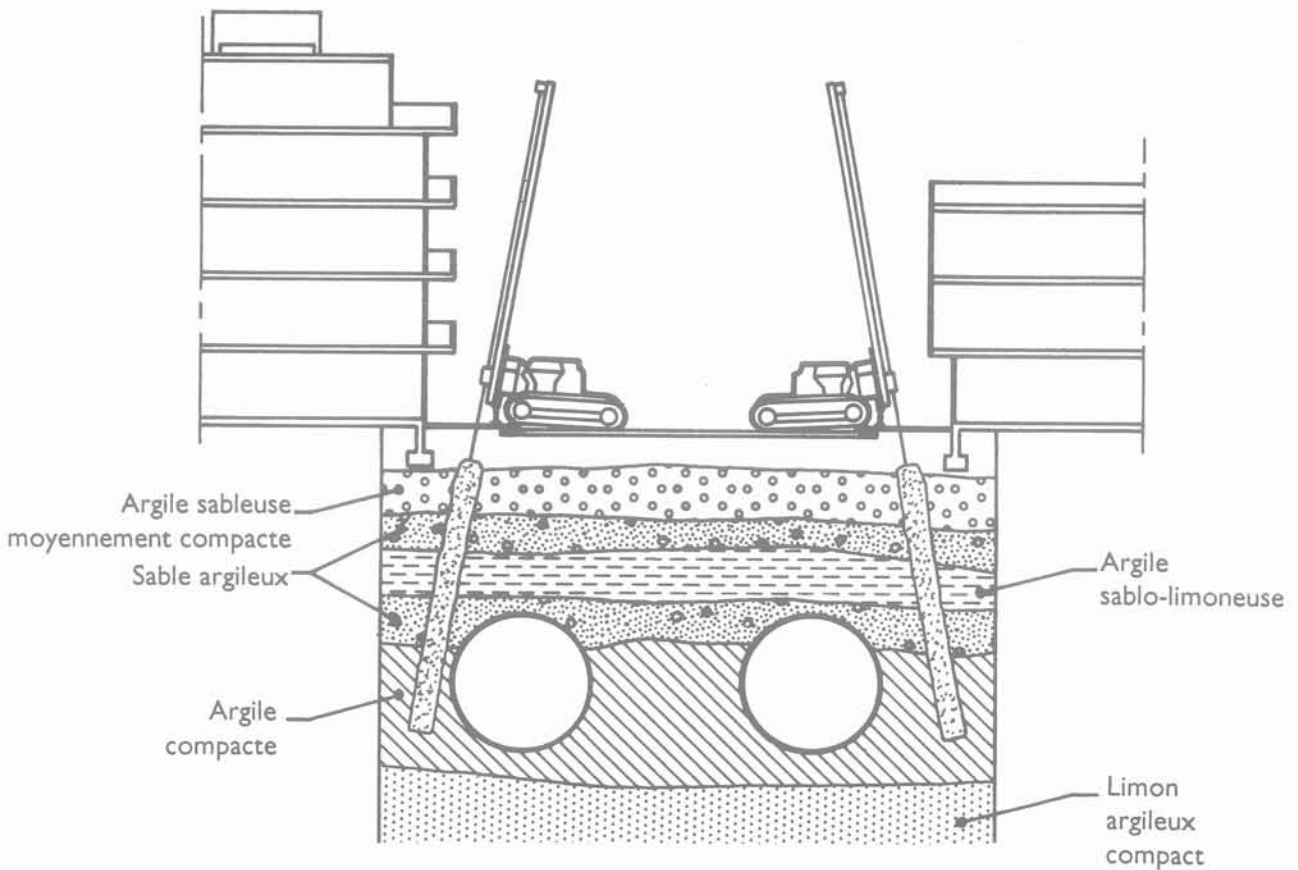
Métro de Caracas, protection d'immeubles au droit du passage de tunneliers.
